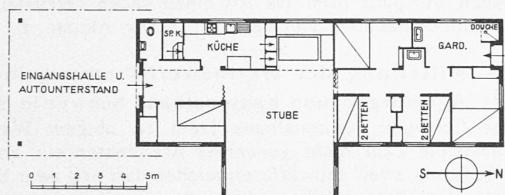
Sommerhaus am Zürichsee. — Grundriss 1 : 300.
